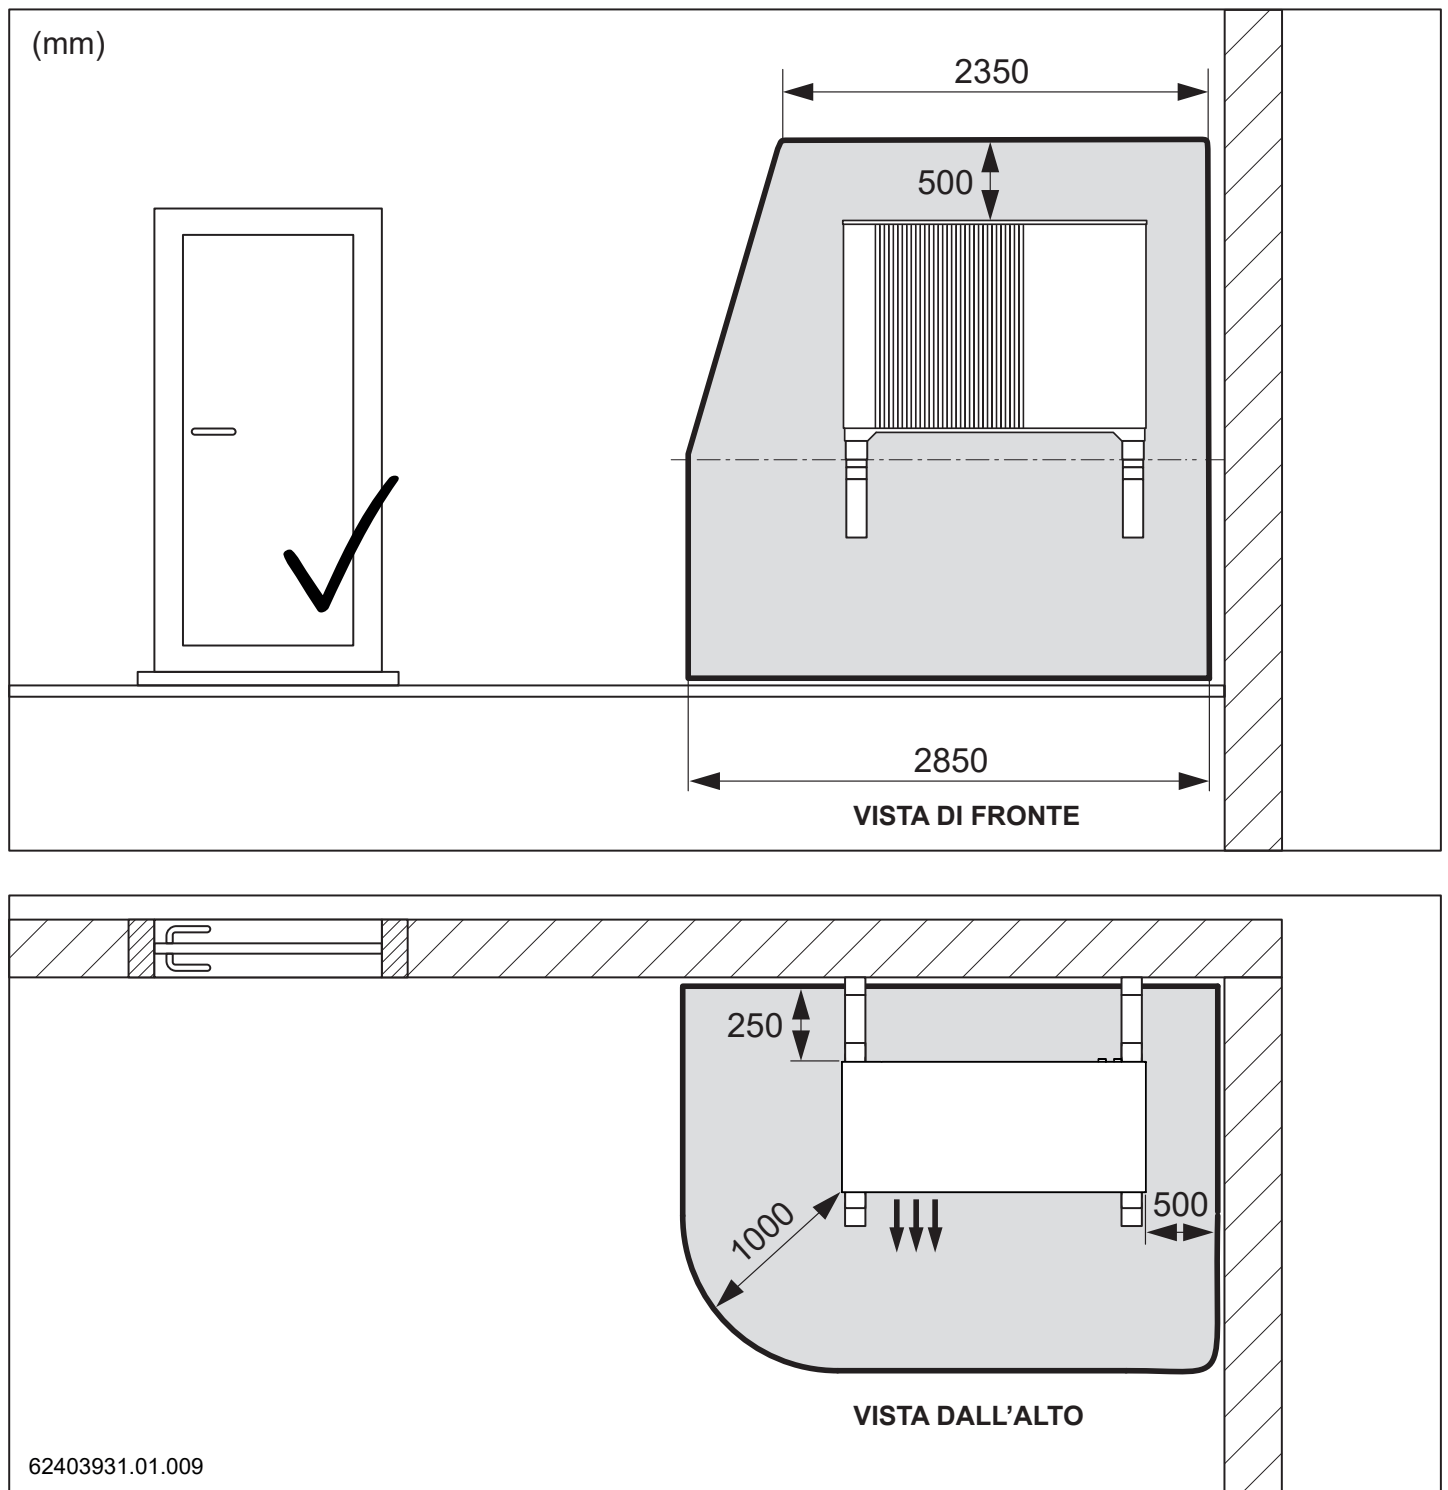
Installazione a parete in un angolo dell'edificio (misure in mm)
